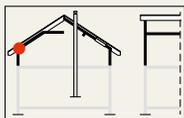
Jonction rampant – mur maçonné isolé par l'extérieur
